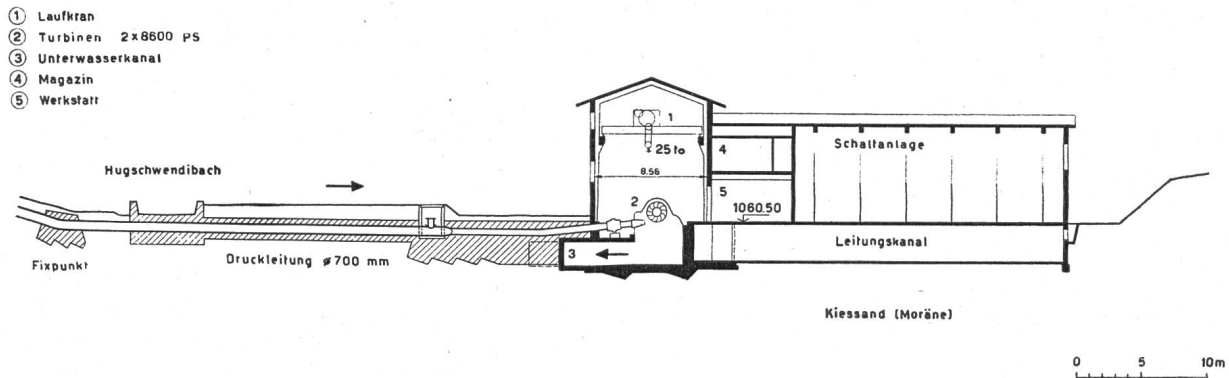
Maschinenhaus Hugschwendi, Schnitt durch Maschinensaal und Schaltanlage
